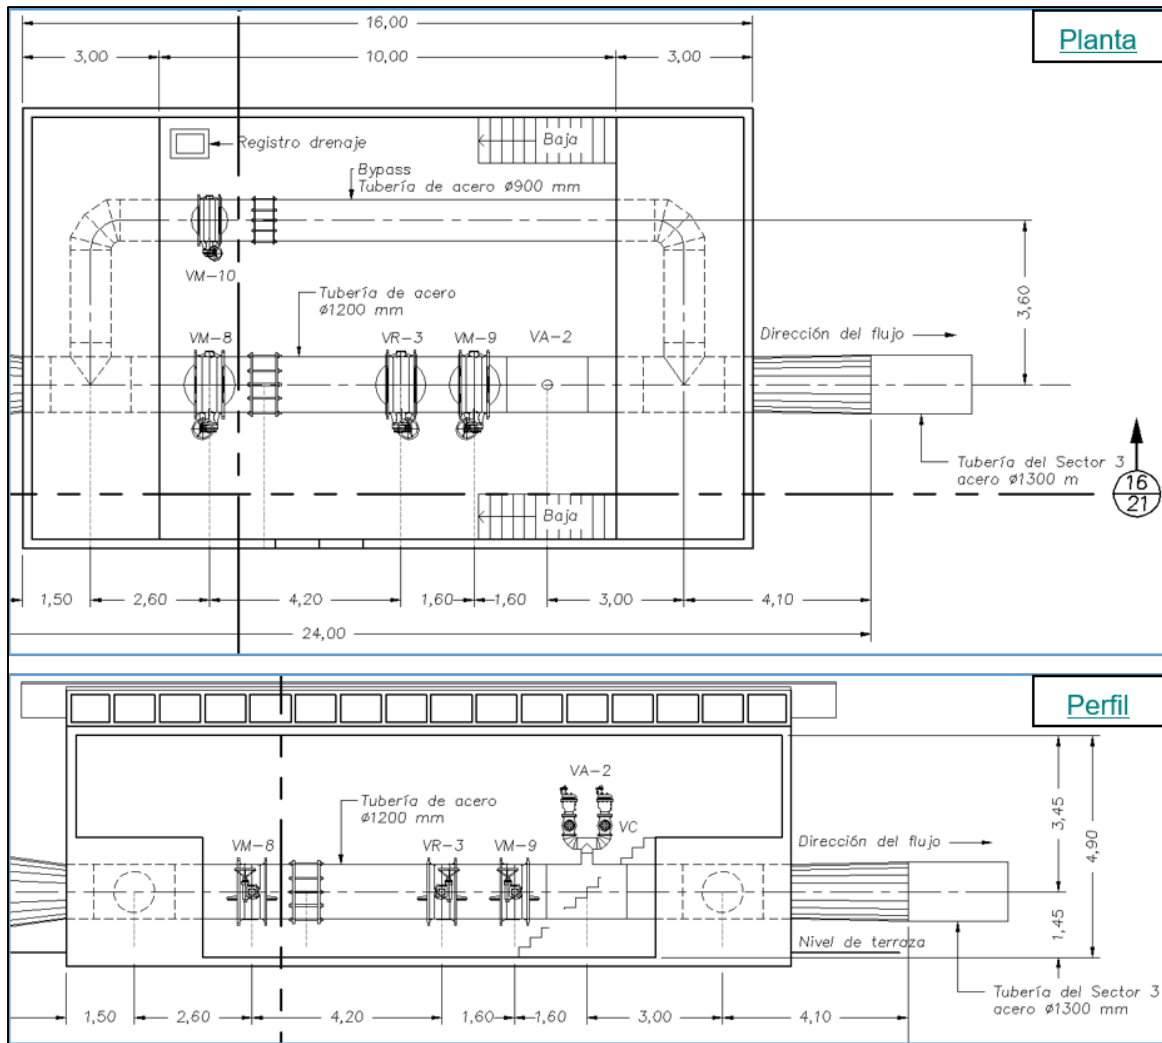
Casa de Válvulas (CV-3) – Portal de Salida Túnel “El Llano”.
